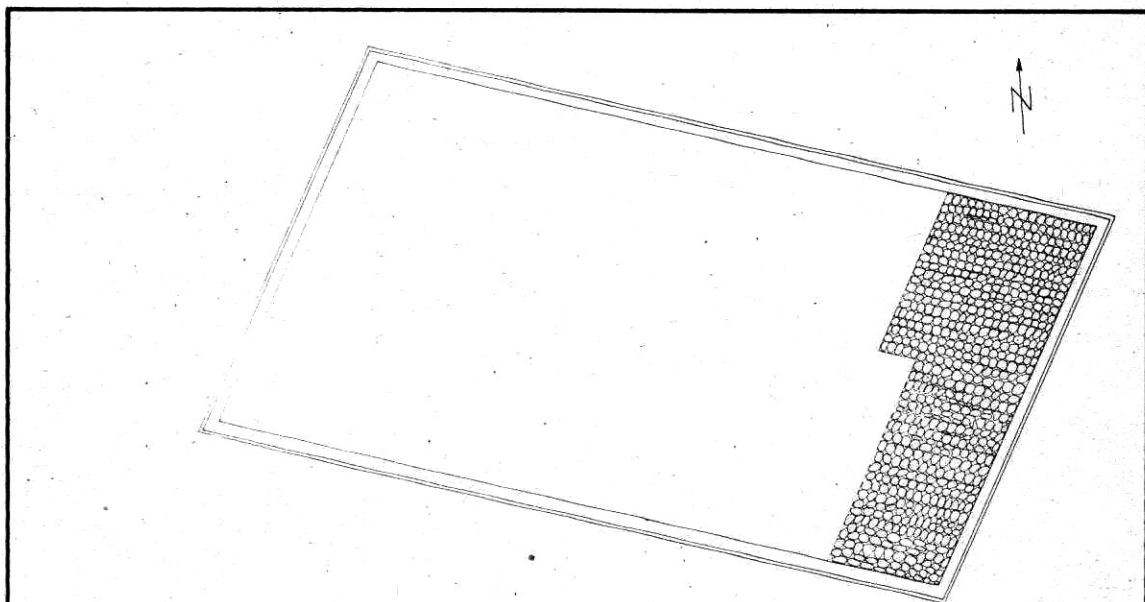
Planta Edificio 50. Tzompantli. Levantó Alejandro Arenas Villalón
